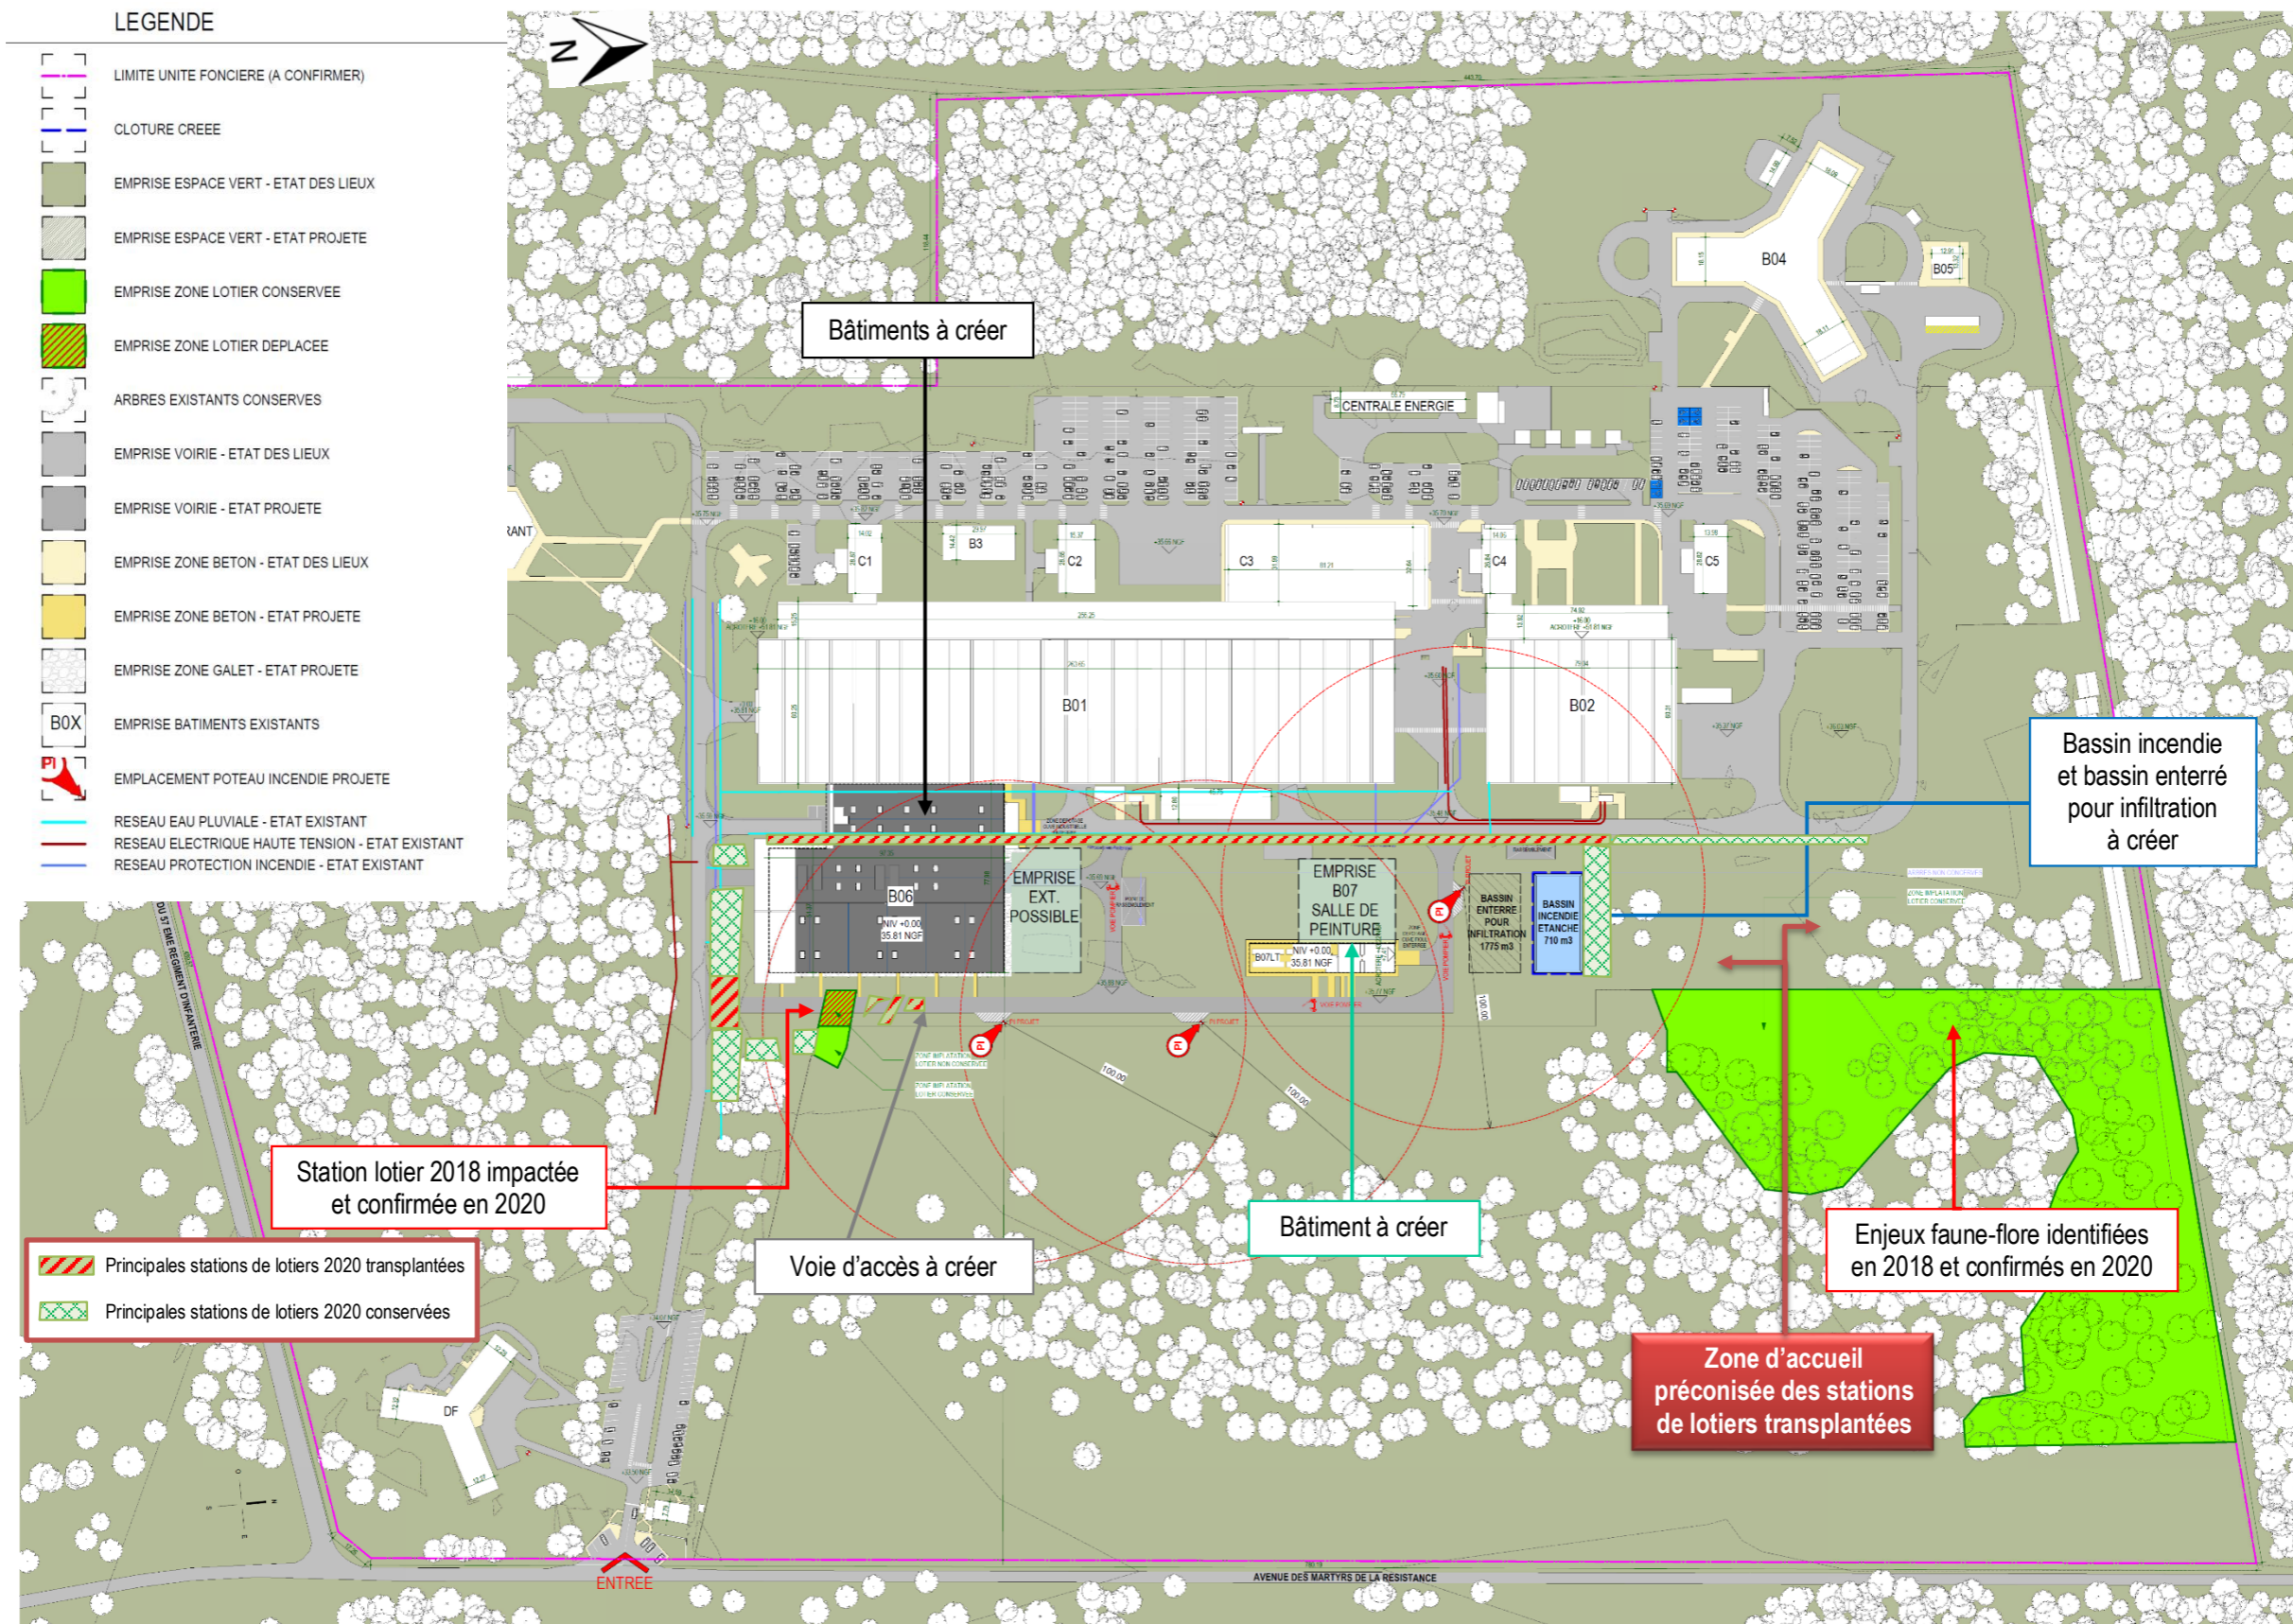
Plan de masse du projet de 2020 (plan de DASSAULT AVIATION).
